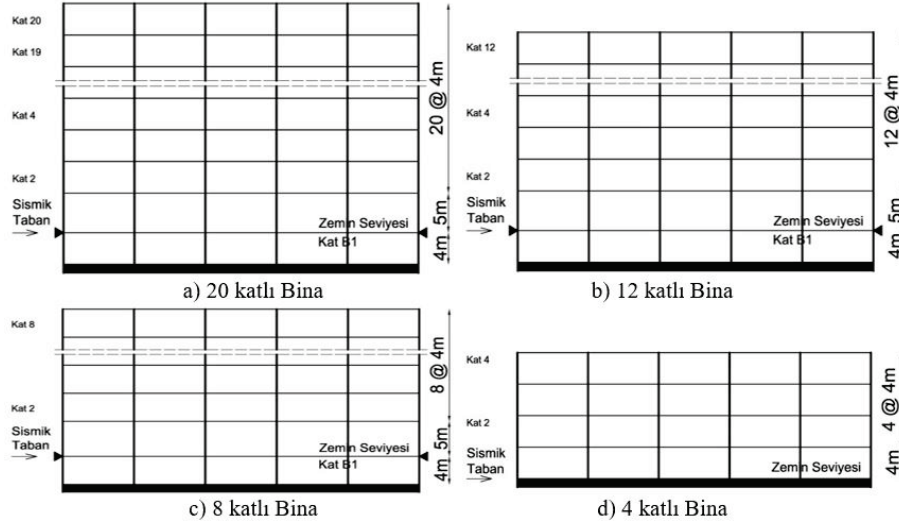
Dört farklı durum için tipik kat planları (Typical plan views for four cases)
